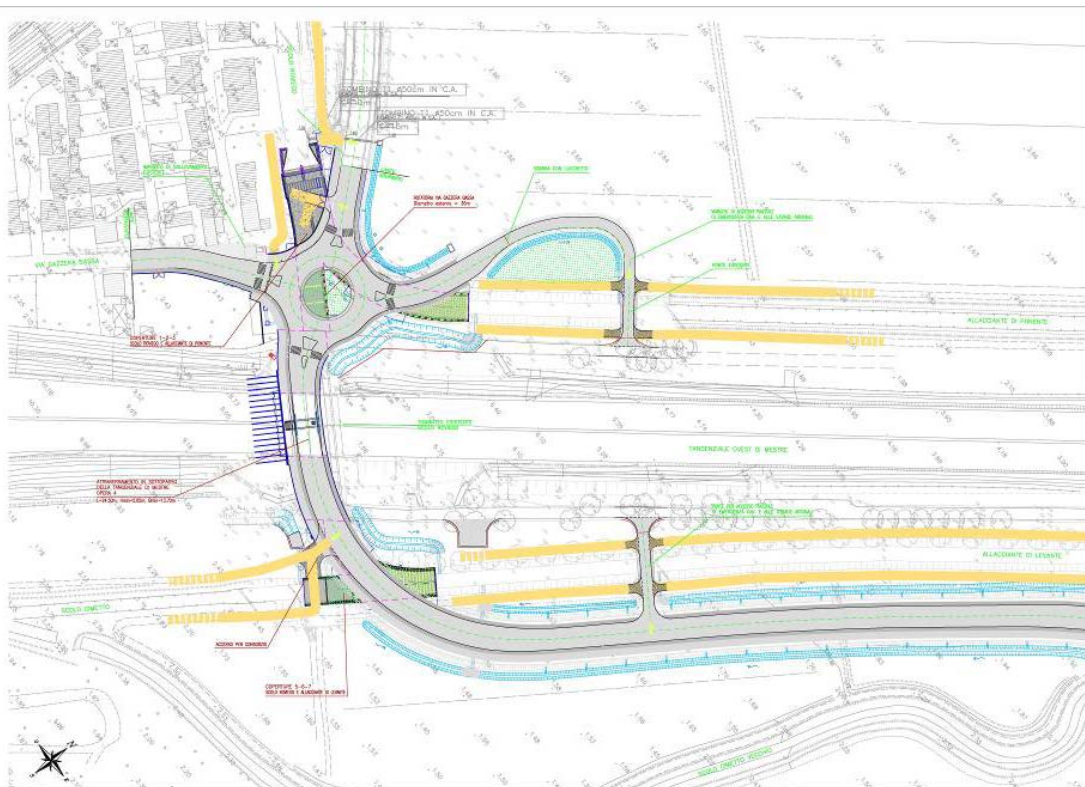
Percorsi argini consortili – Stralcio planimetrico zona sud
